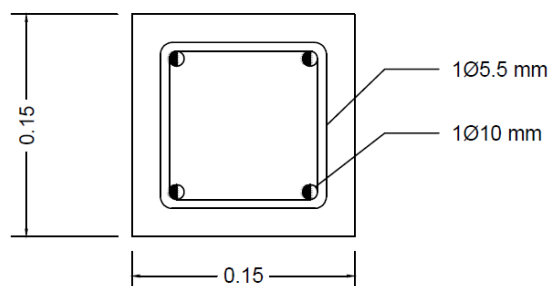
Detalle del refuerzo de las columnas y vigas
